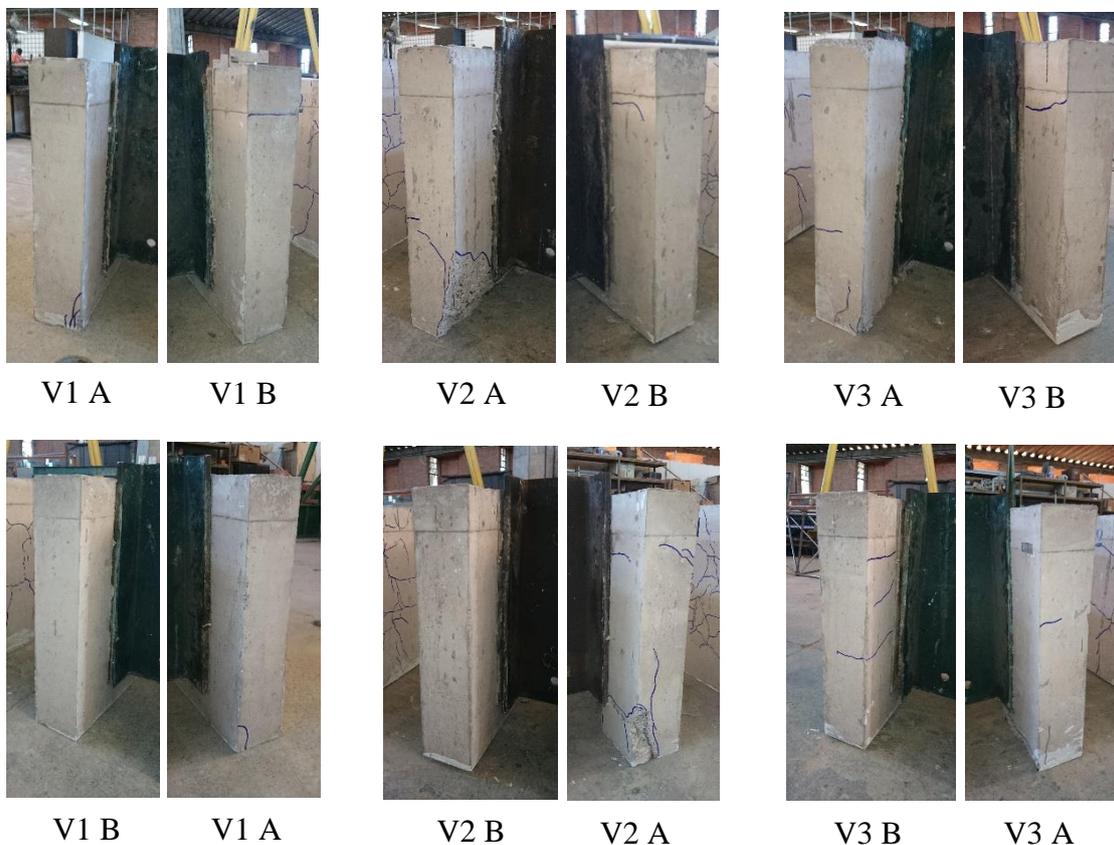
Vistas laterais e internas das lajes dos modelos.
